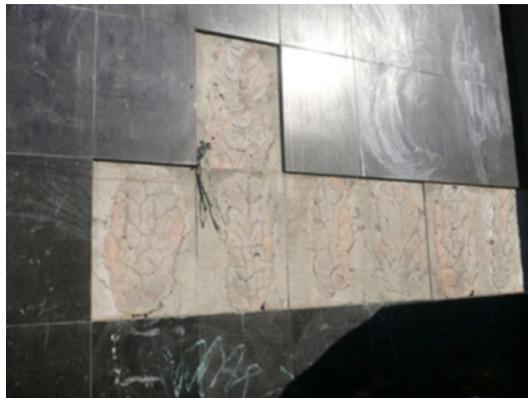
Deslocamento de peças de granito preto assentadas em fachada com argamassa.
